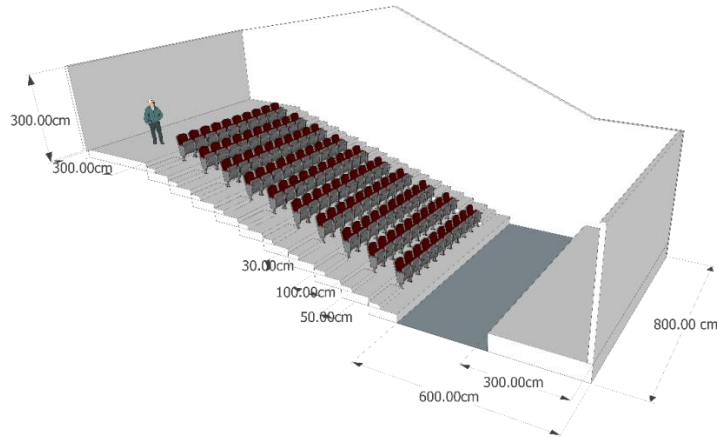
10 Denah Kebutuhan Ruang Mini Theater
